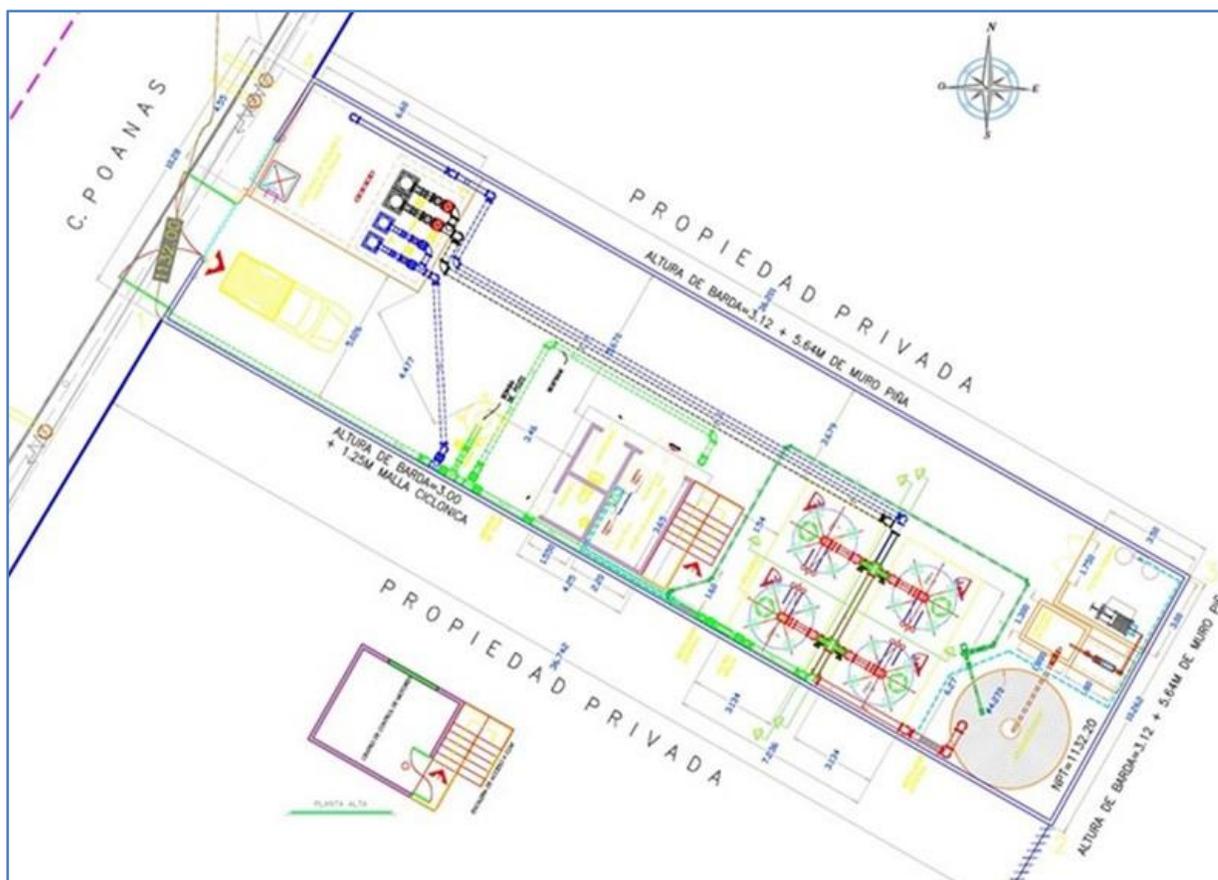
Propuesta de arreglo general de equipo planta pozo 13-A
